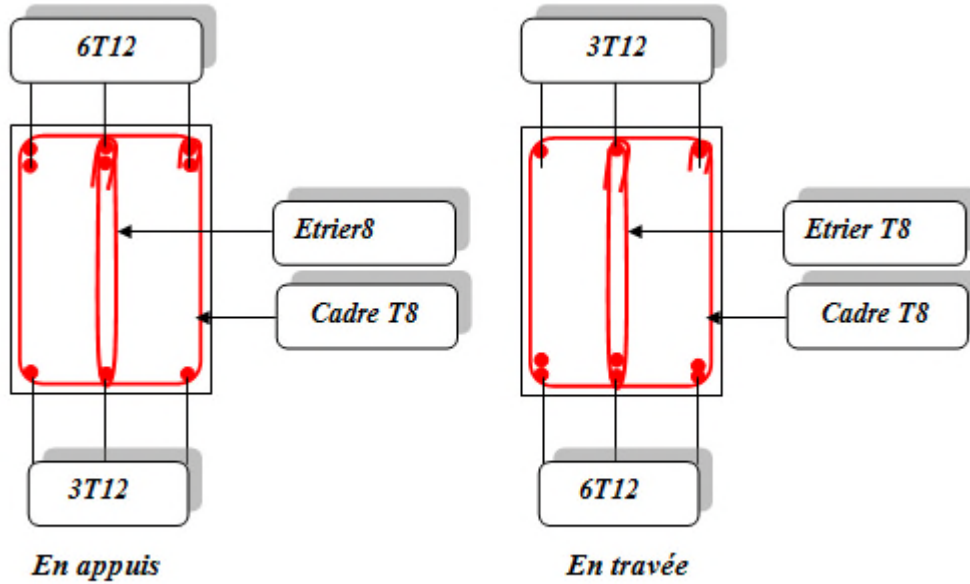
Ferrailage de la poutre secondaire (RDC+4 étage +3 entres sols)
